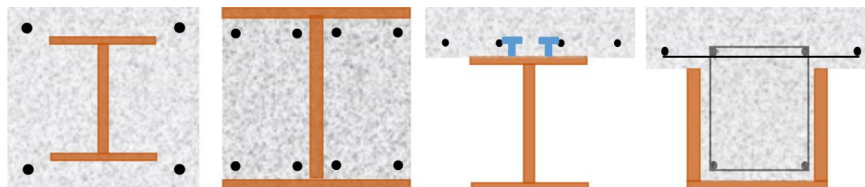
Tipos esquemáticos de vigas mistas Aço-Concreto
